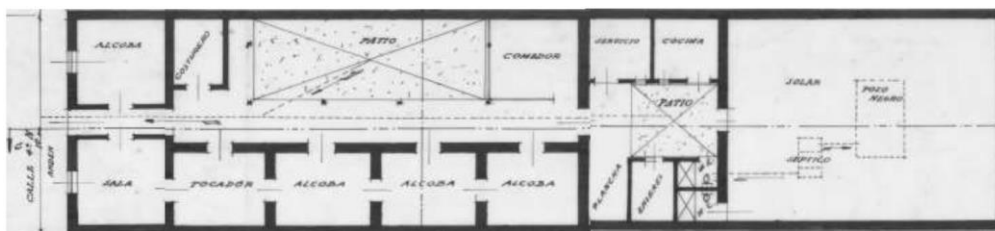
Planta dividida en dos partes de la vivienda del Sr. Ernesto Lloreda, Calle. 4 Carrera. 16-17. Barrio la Mutualidad.
